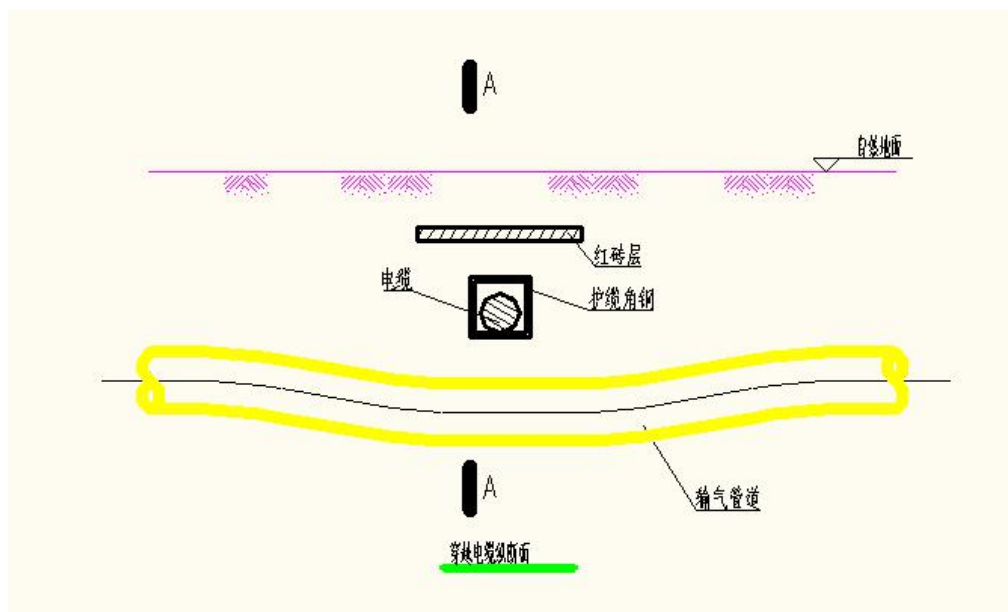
管道与光（电）缆交叉穿越断面示意图
